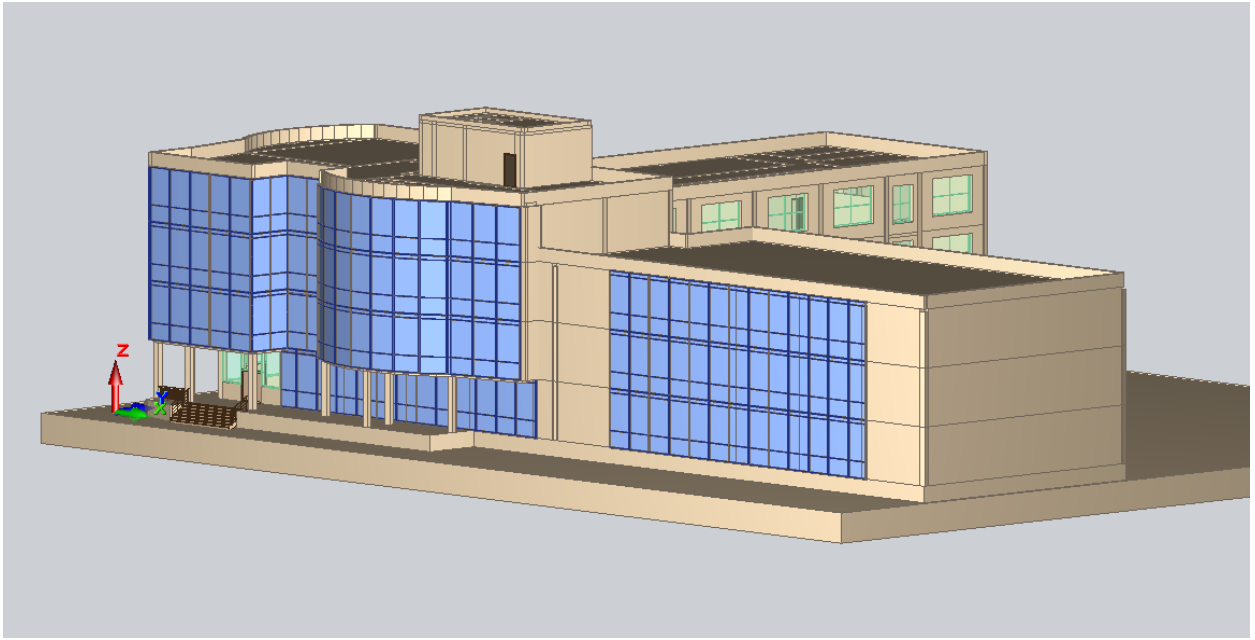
3D модель нового корпуса КнАГУ в ПК САПФИР
